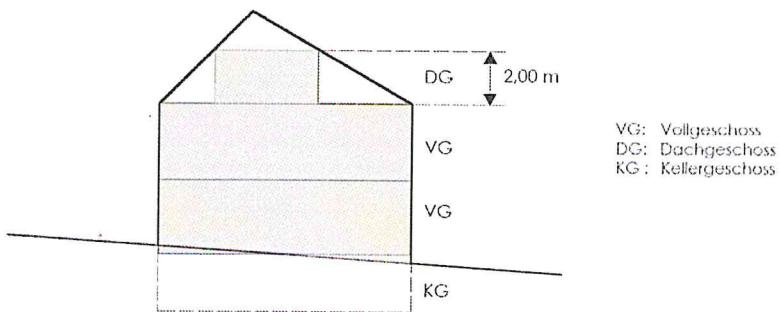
Schema zur Bemessung der anrechenbaren Wohnfläche
